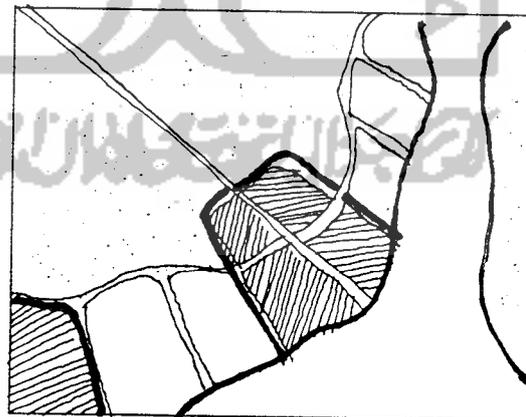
Alternatif Pencapaian Kelokasi / Site
